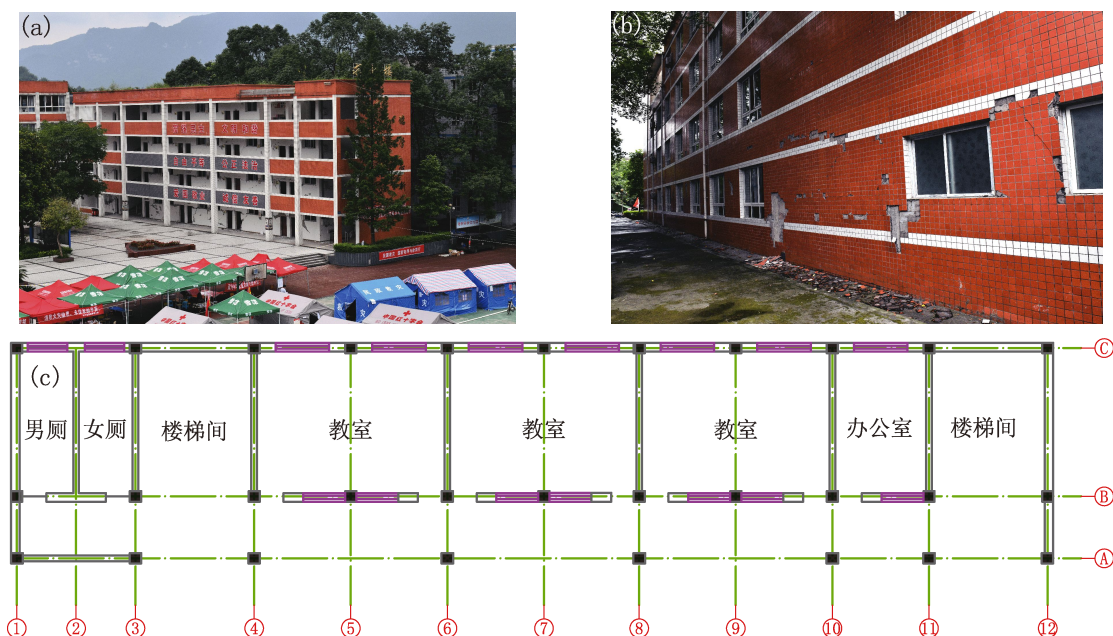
双河中学教学楼正面 (a)、背面 (b) 和一层平面图 (c)
